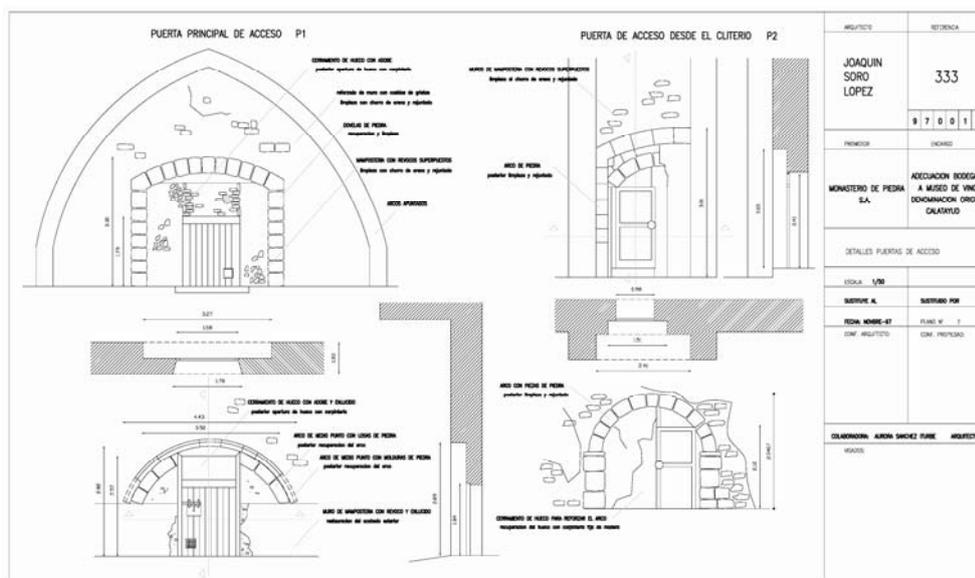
([AJS] Proyecto Nov 1997, plano 7) DETALLES PUERTAS DE ACCESO
